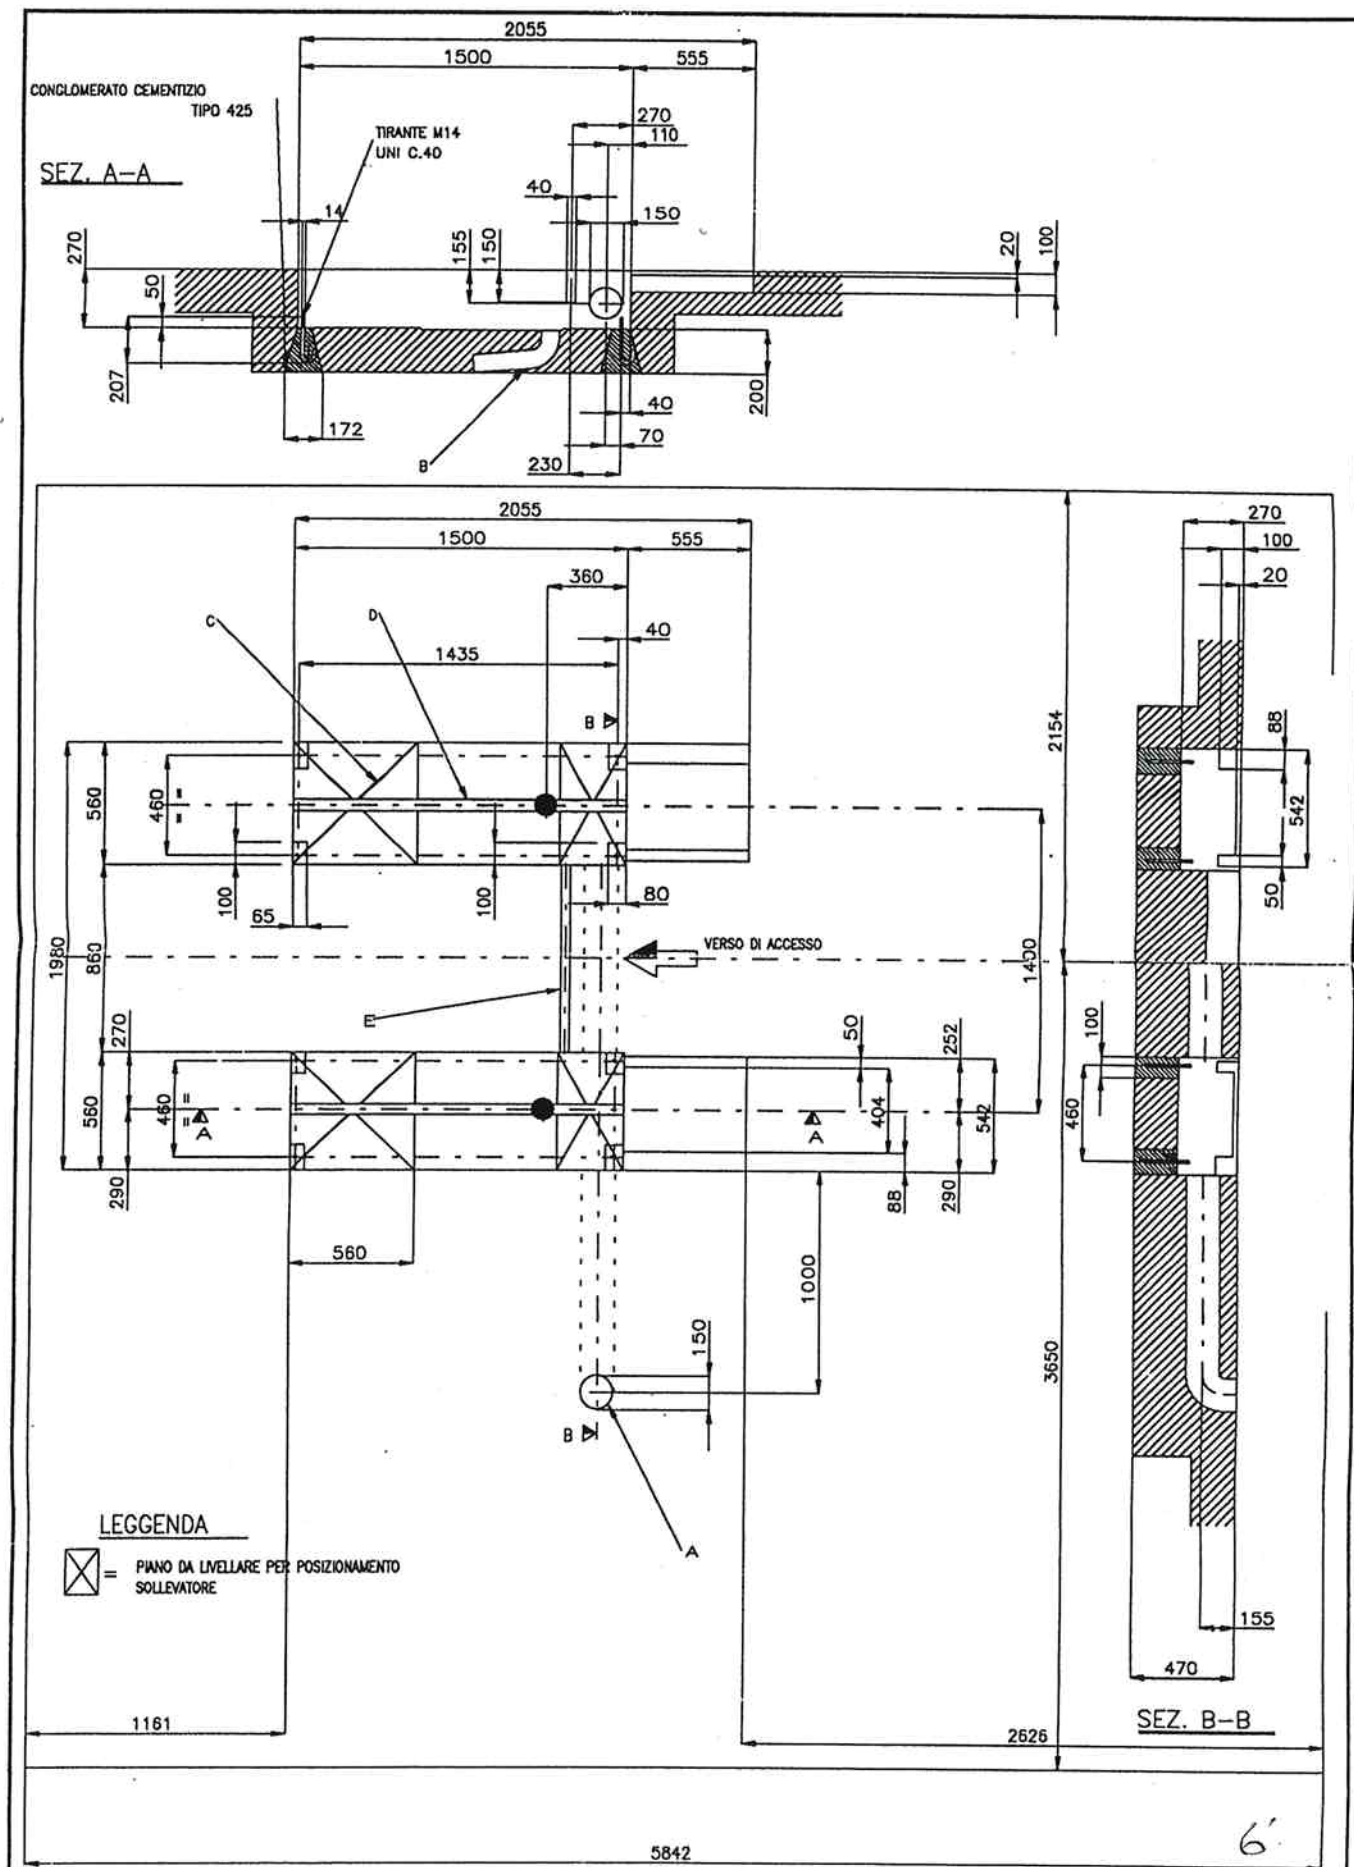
Planimetria dell'incasso TITAN X 250
